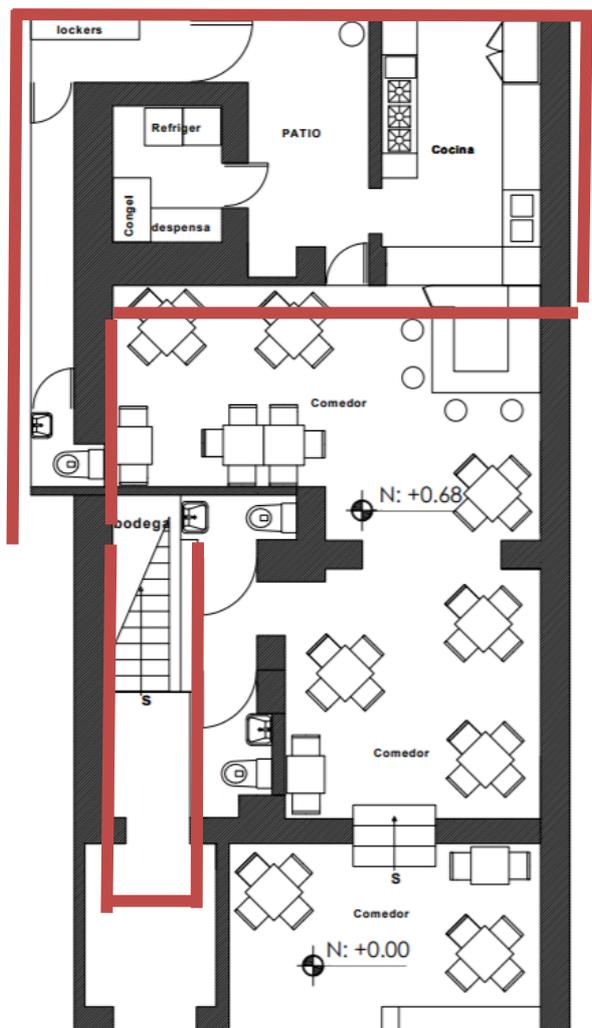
Plano arquitectónico con delimitaciones back of the house. Fuente: del Autor
